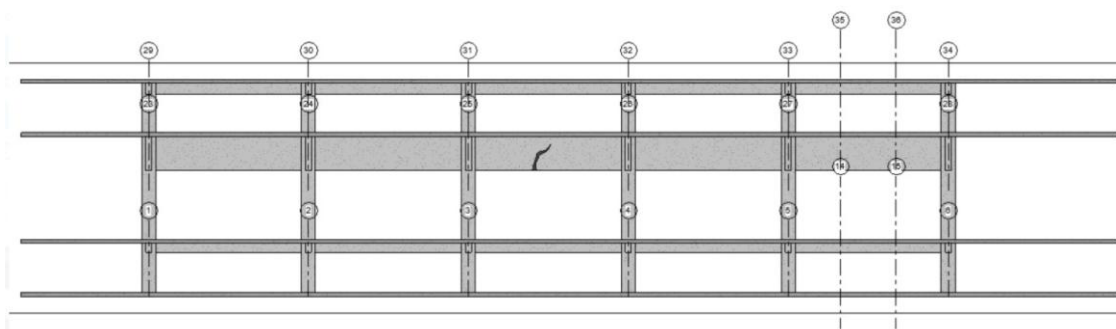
Vista a corte de la patología identificada en la viga Fuente: Elaboración propia.
